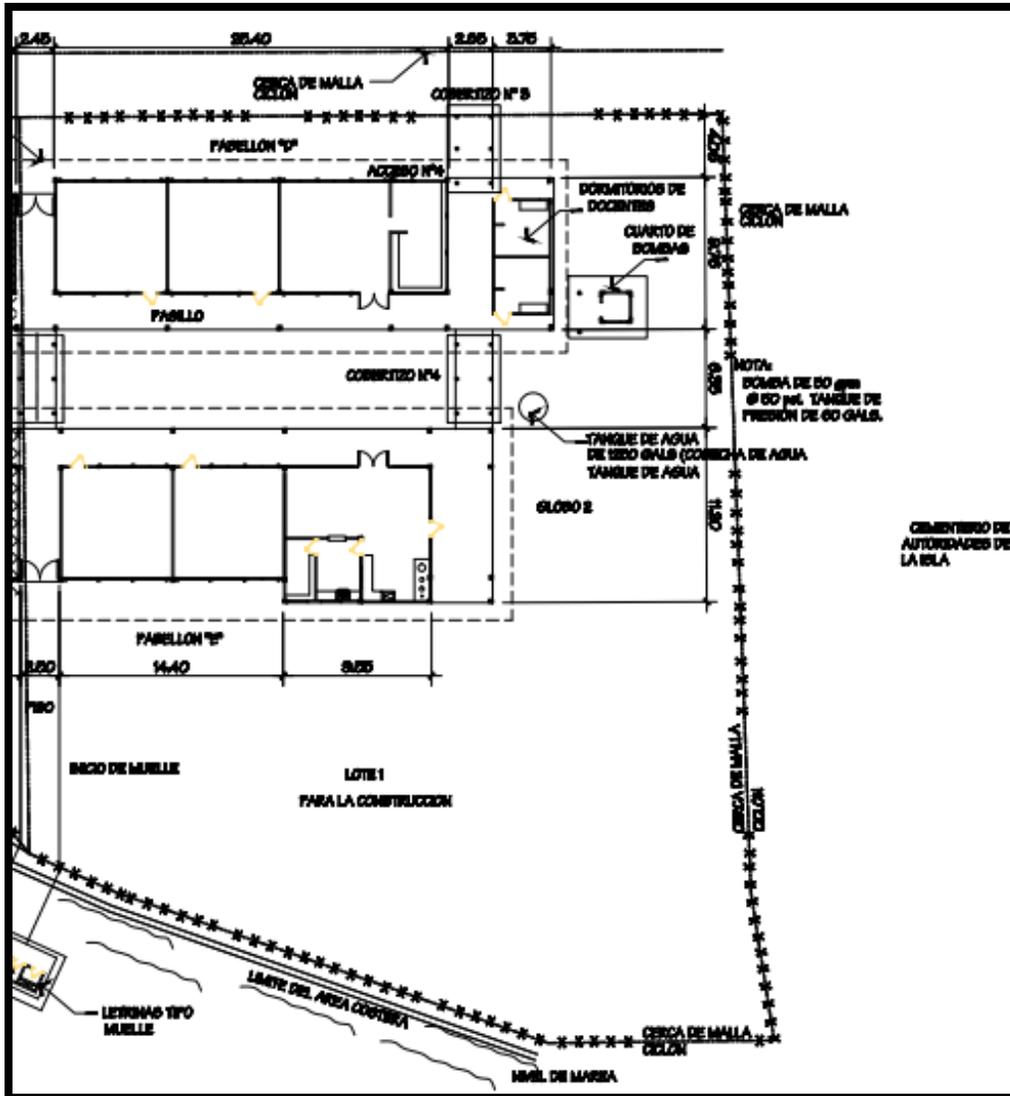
Vista de Planta de las nuevas estructuras a construir.
